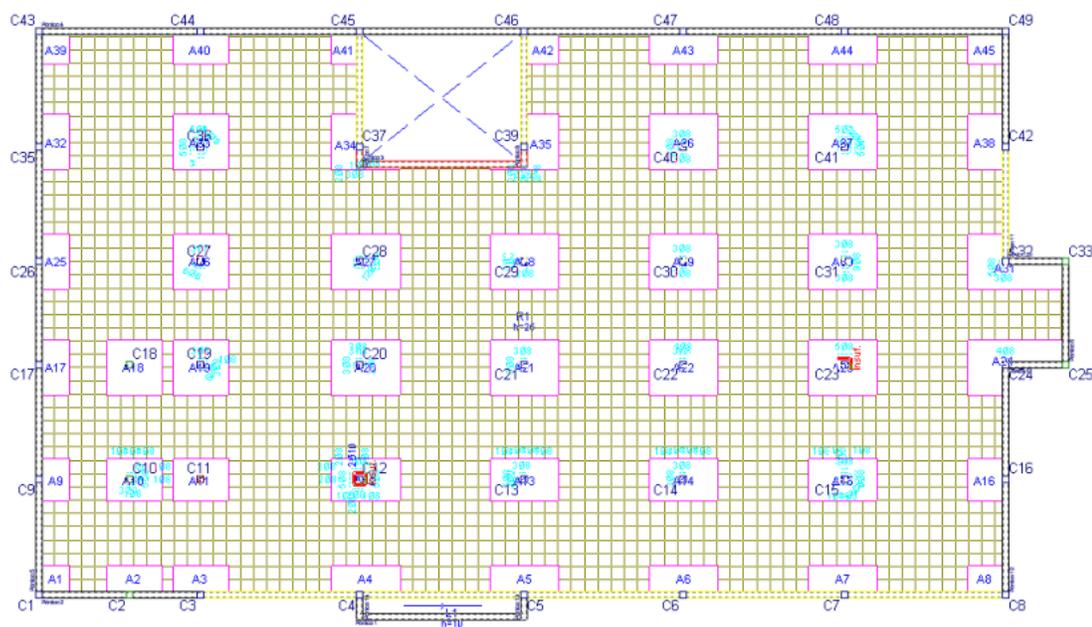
Vista en planta losa $h=25\text{cm}$ sin vigas de arriostre.²
